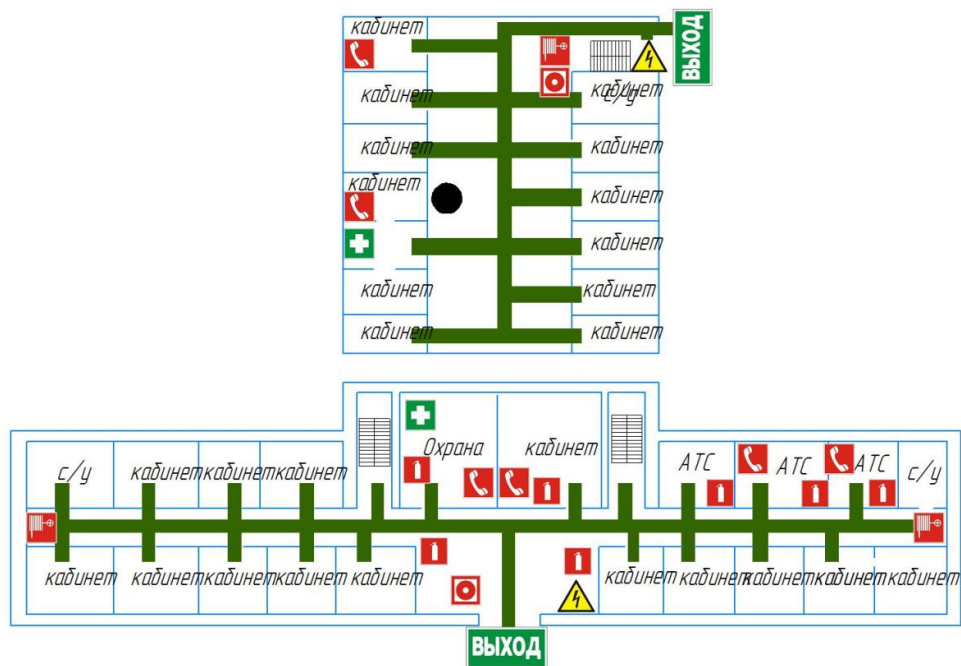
План эвакуации из помещений 1 этажа здания управления
